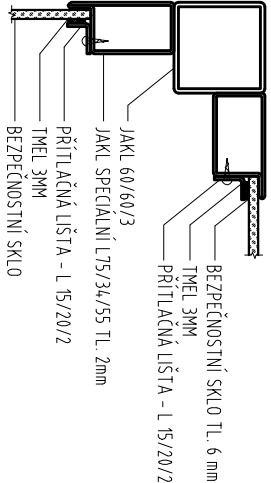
DETAIL NAPOJENÍ VÝTAHOVÉ KONSTRUKCE 1:5
